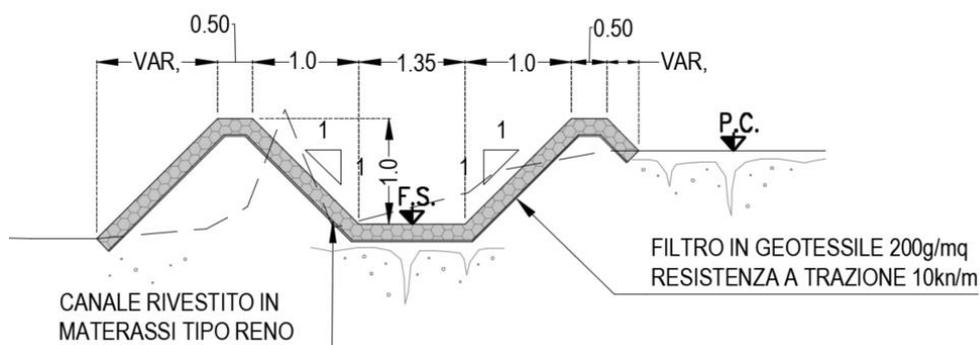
Sezione tipo del canale trapezio rivestito in materassi reno
